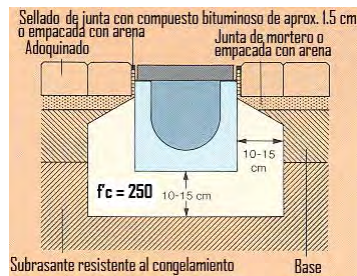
ÁREAS PAVIMENTADAS CON ADOQUINES Y LOSETAS DE CONCRETO O DE PIEDRA NATURAL
